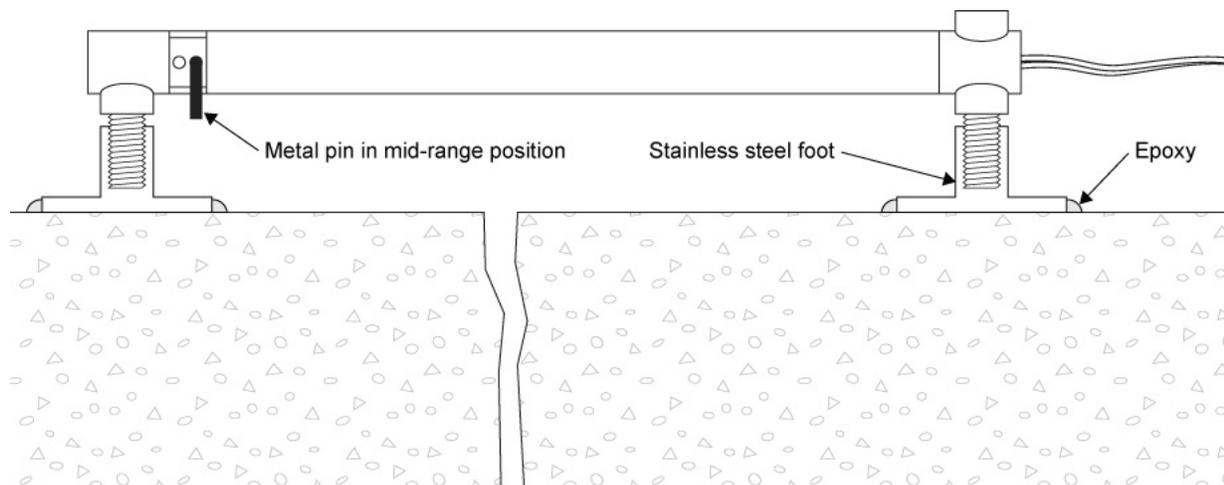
Medidor de grietas en monumentos Modelo 4422-2, tipo de anclaje con lechada
